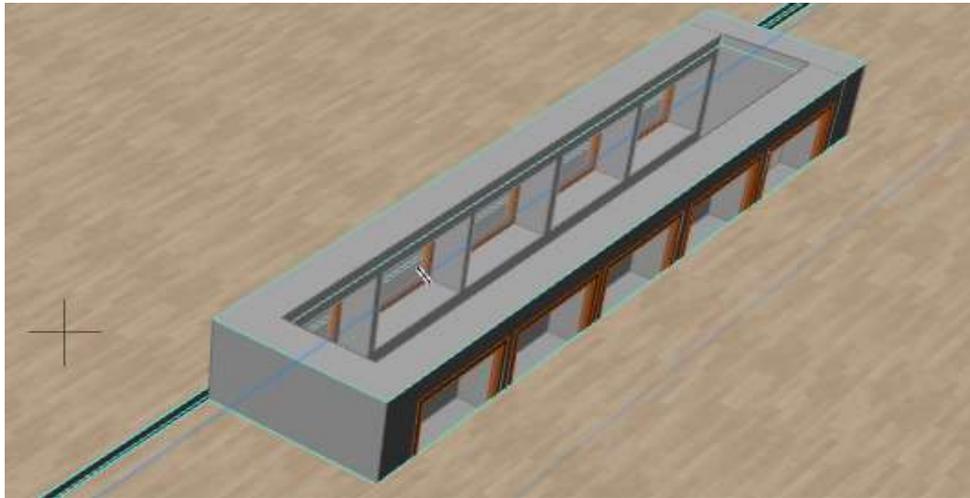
ouverture zénithale utilisée comme correction sur le toit du hall d'exposition, source: archicad22, auteur (2023)
